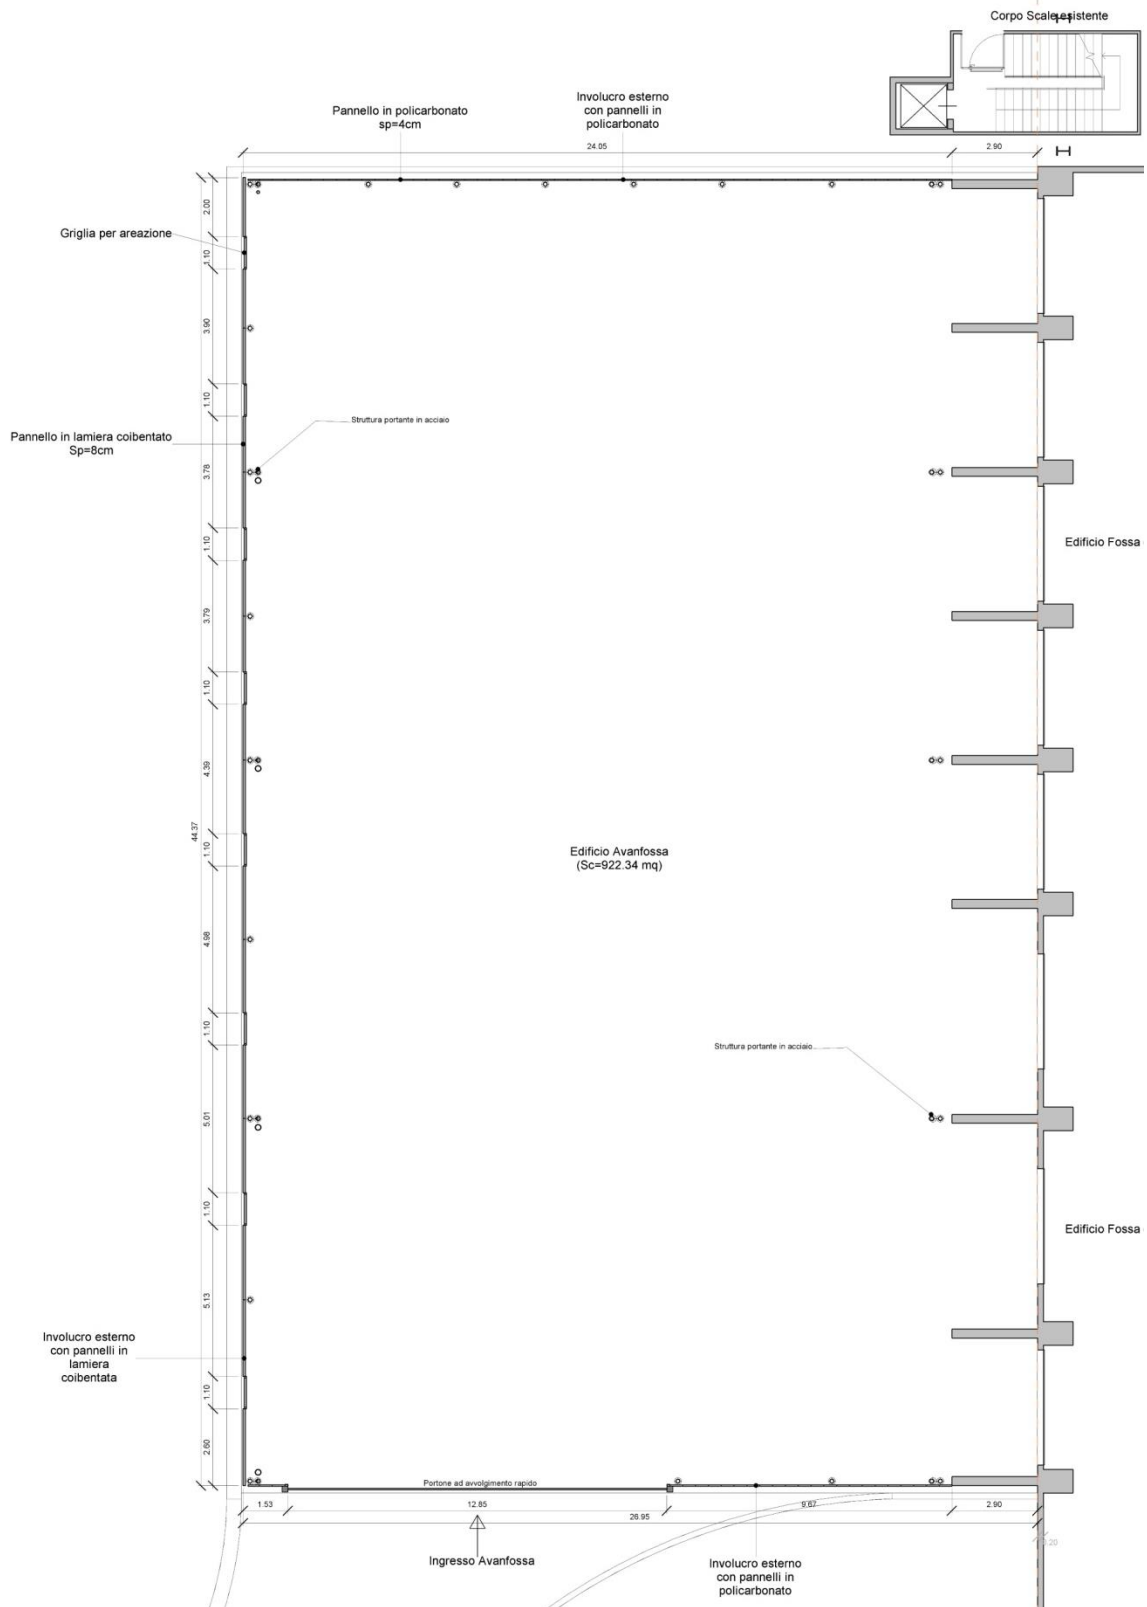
Planimetria Edificio Avanfossa – stato di progetto
